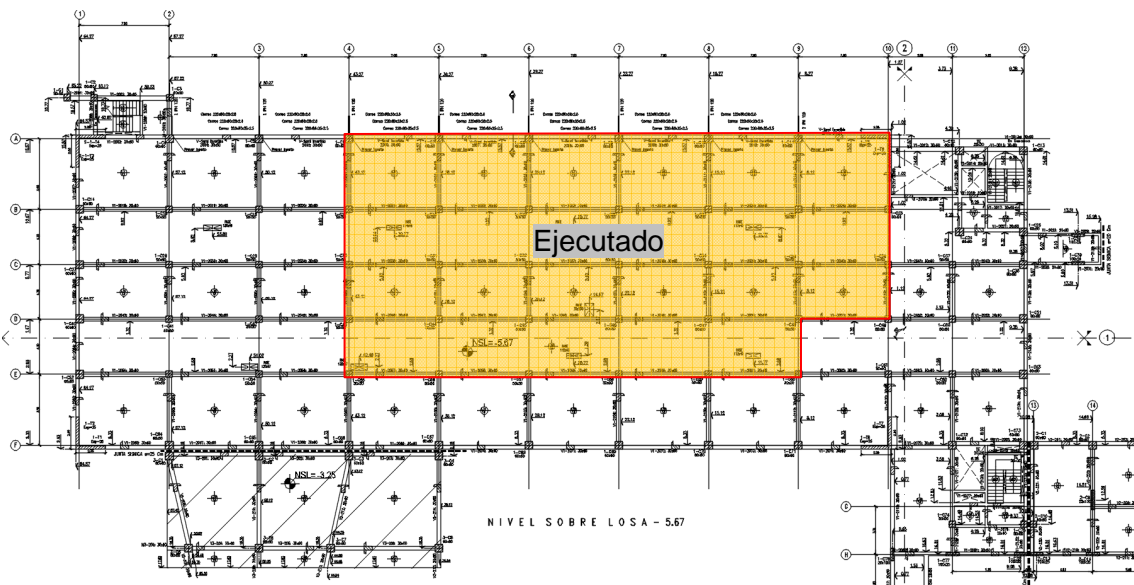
(b): Estructura, Planta Nivel -5m, avance de obra.
